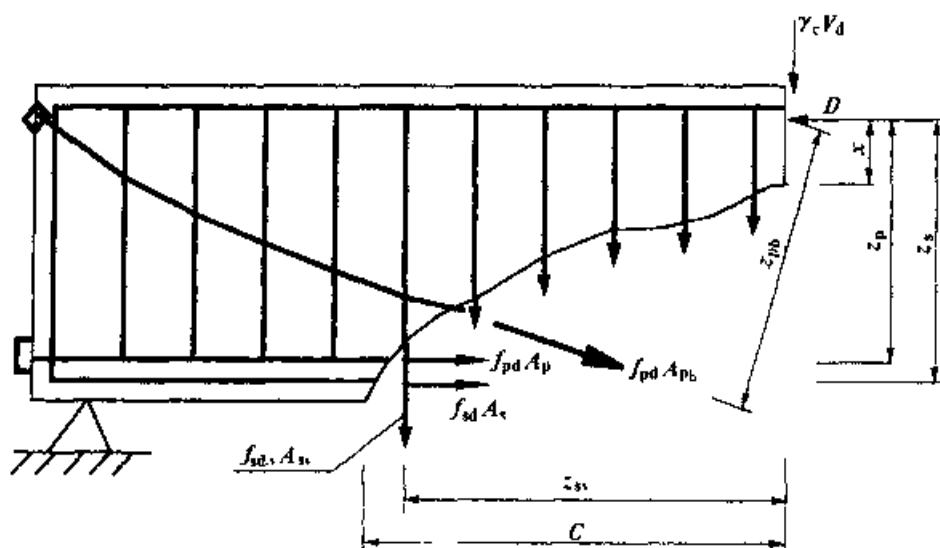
预应力混凝土受弯构件斜截面抗弯承载力计算图式
